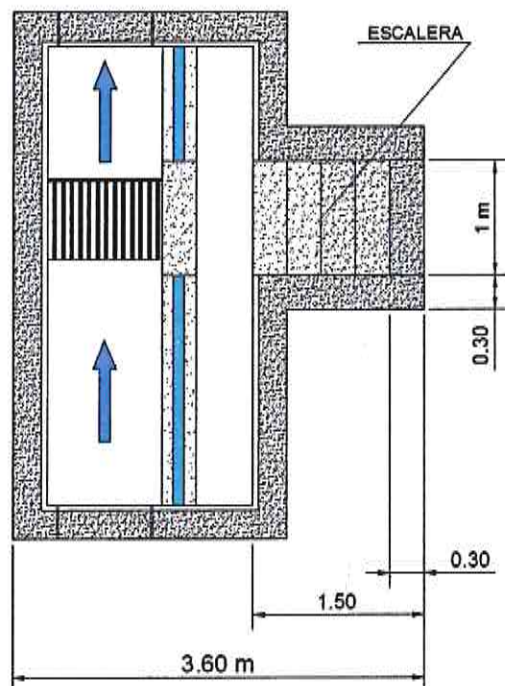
Planta de la arqueta. Fuente: Elaboración propia
